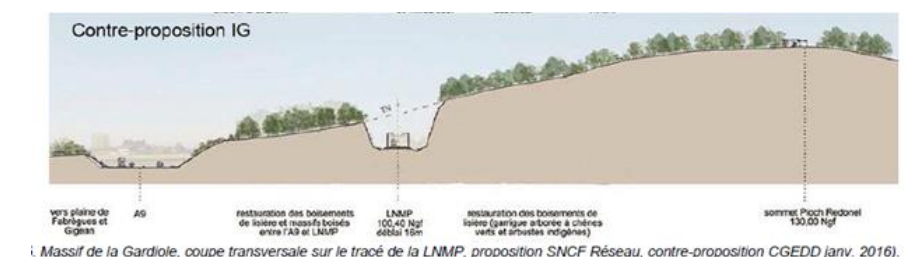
coupe transversale du projet LNMP avec parois subverticales - la Gardiole
